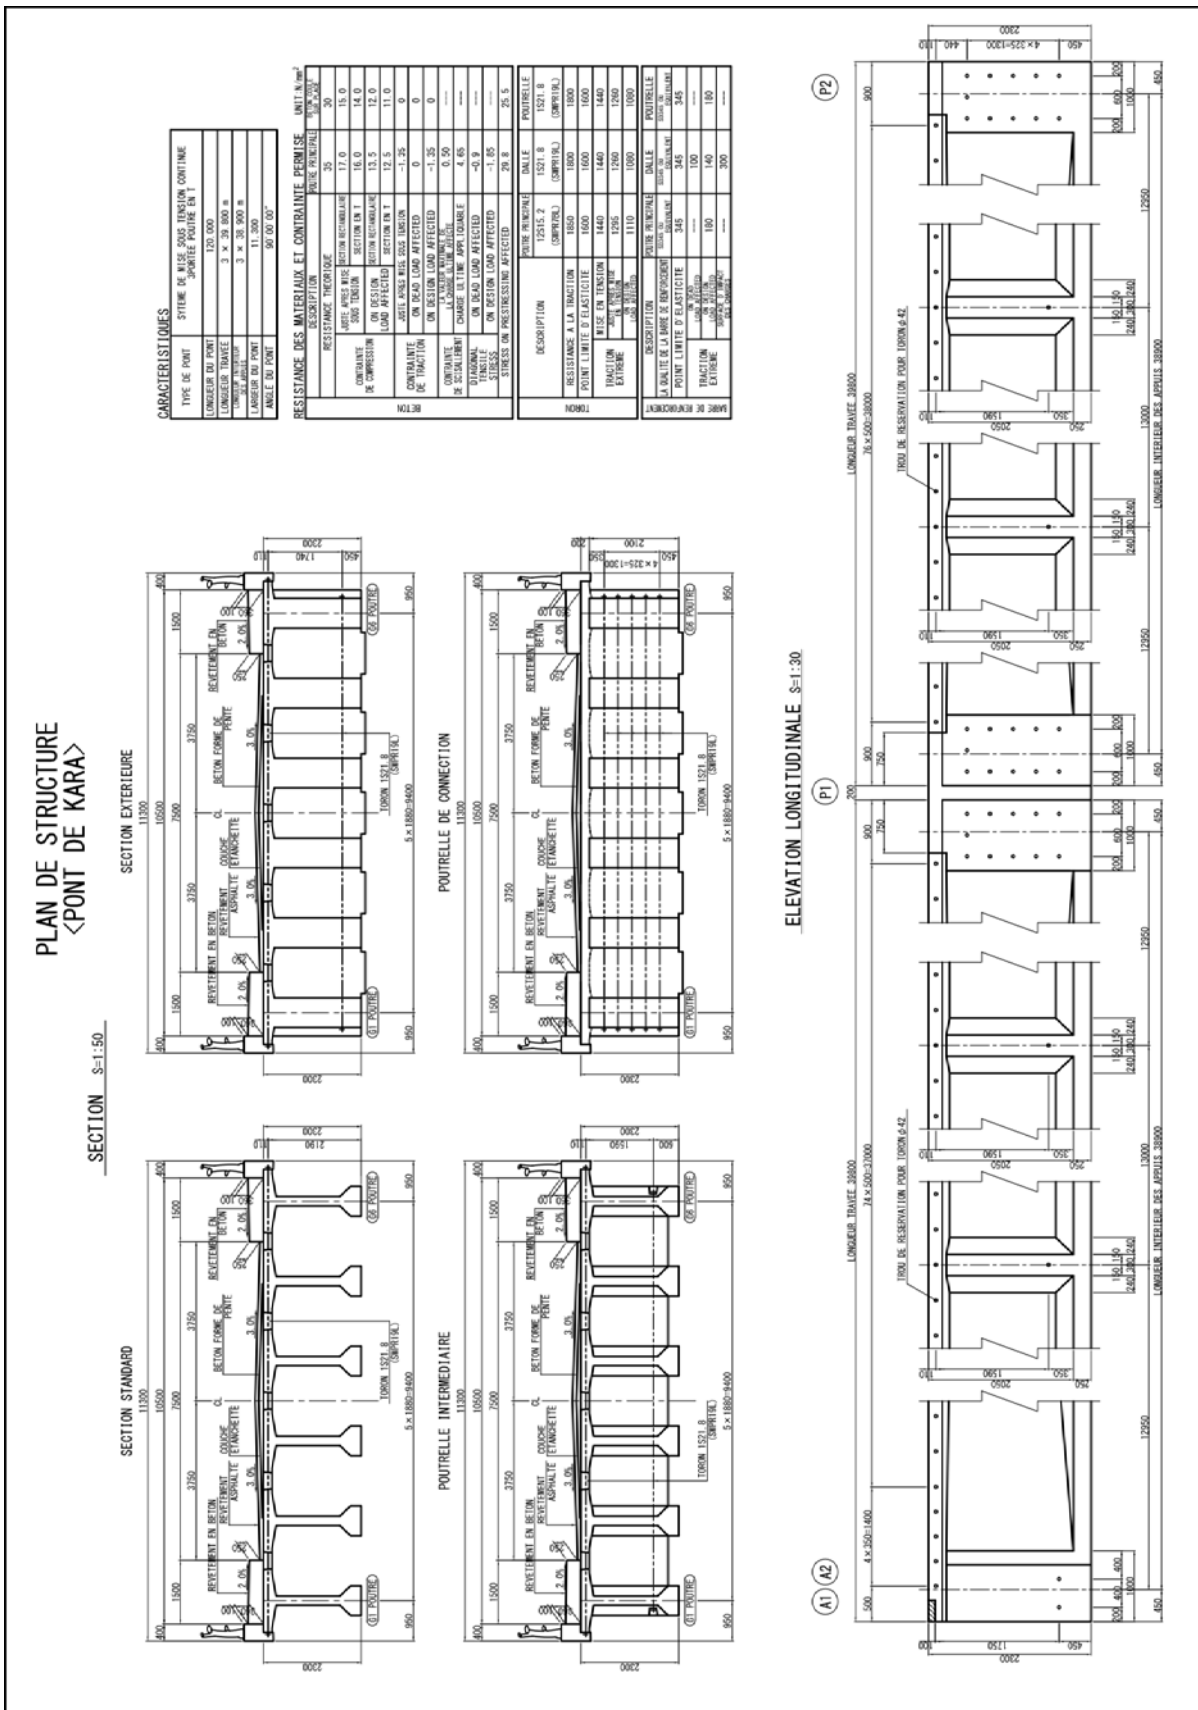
Plan de construction de la superstructure du pont sur le fleuve Kara
